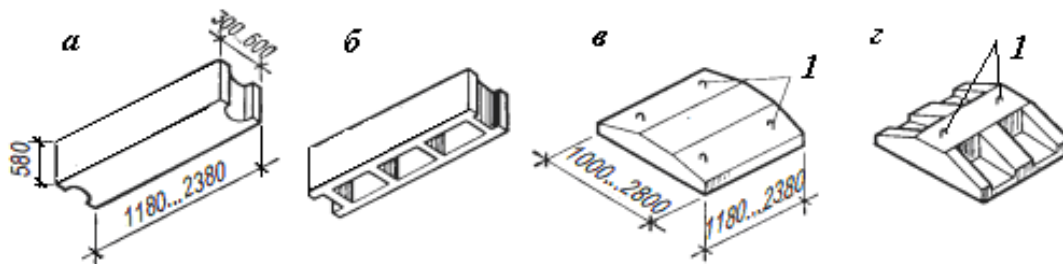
Елементи збірних бетонних і залізобетонних фундаментів: а – бетонний блок суцільний; б – те саме, порожнистий; в – фундаментна плита; г – те саме, ребриста; 1 – монтажні петлі
